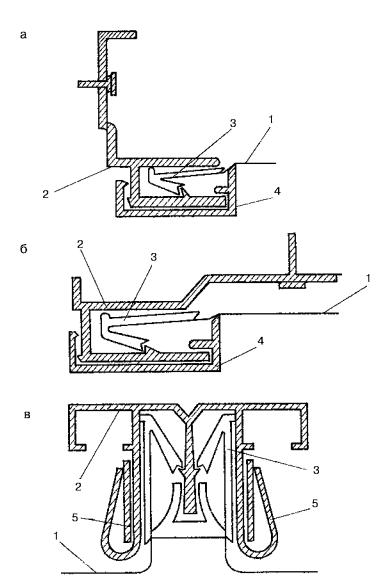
Элементы конструкции натяжного потолка фирмы «Extenzo»: а, б— с багетами из пластика; в— с алюминиевым разделителем; 1— пленка; 2— багет; 3— гарпун полужесткий; 4— накладка;
